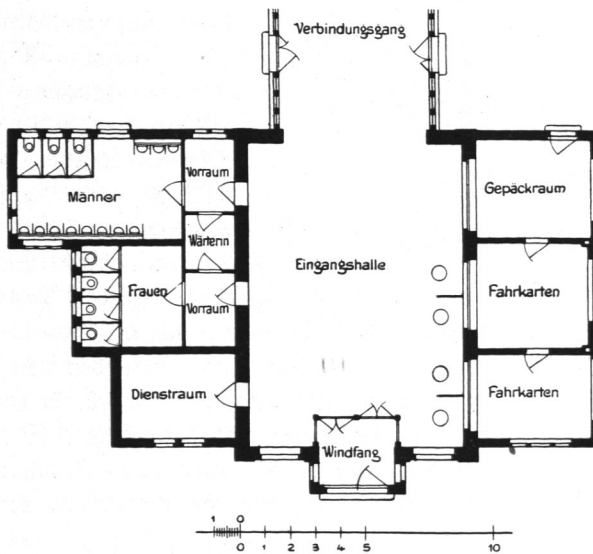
Haltestelle Döhlendorf, Grundriß des Erdgeschosses.
